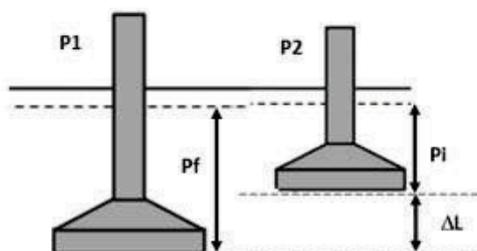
Ilustração do recalque de fundações após colapso de solo em fundação direta.
